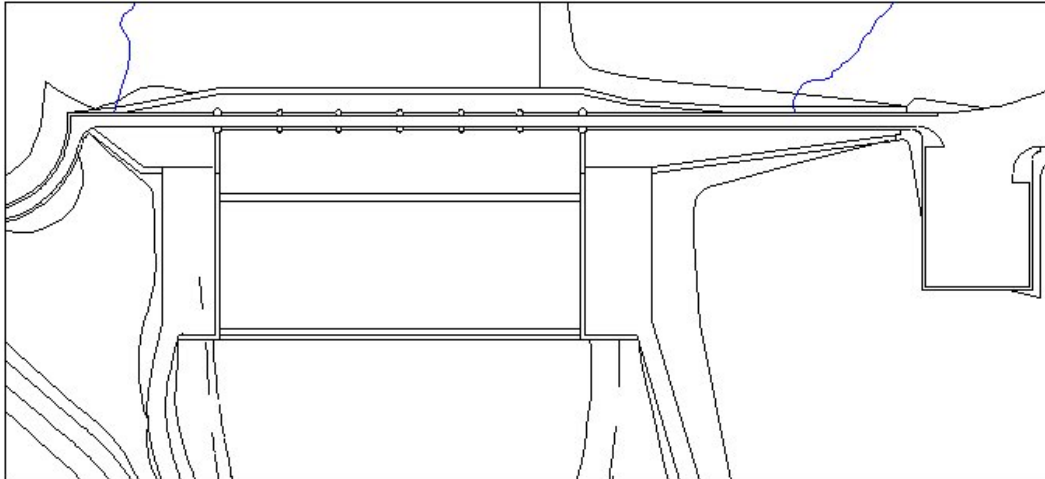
Planta de la estructura de la presa José Bautista. Escala 1:2300.
